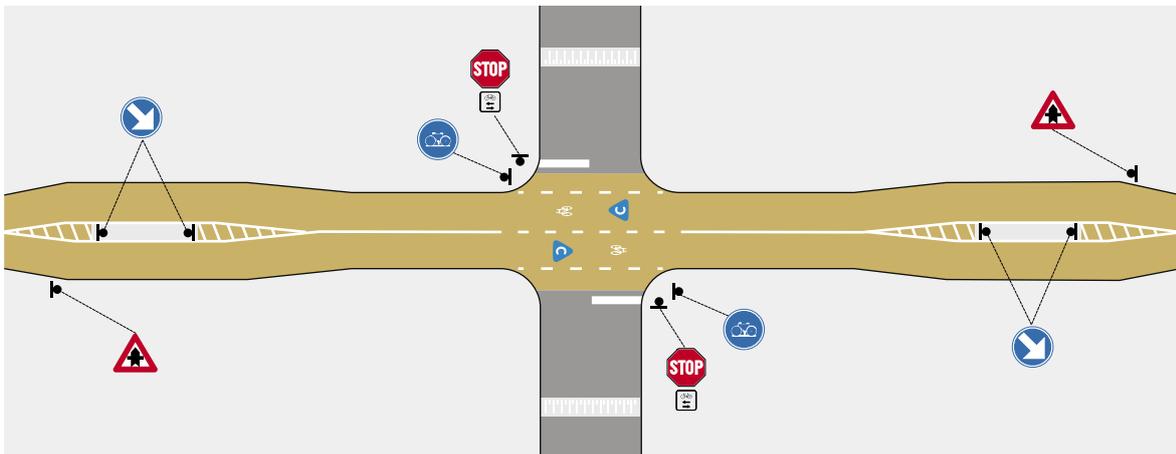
Solution croisement cyclostrade prioritaire, avec panneau stop sur la voie secondaire.
